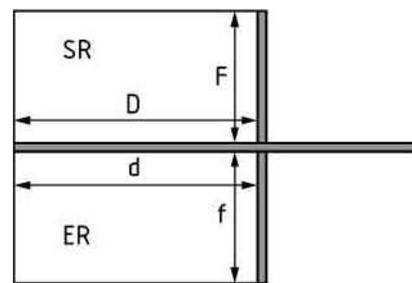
Abgewinkelte trennende und flankierende Bauteile, Grundriss
